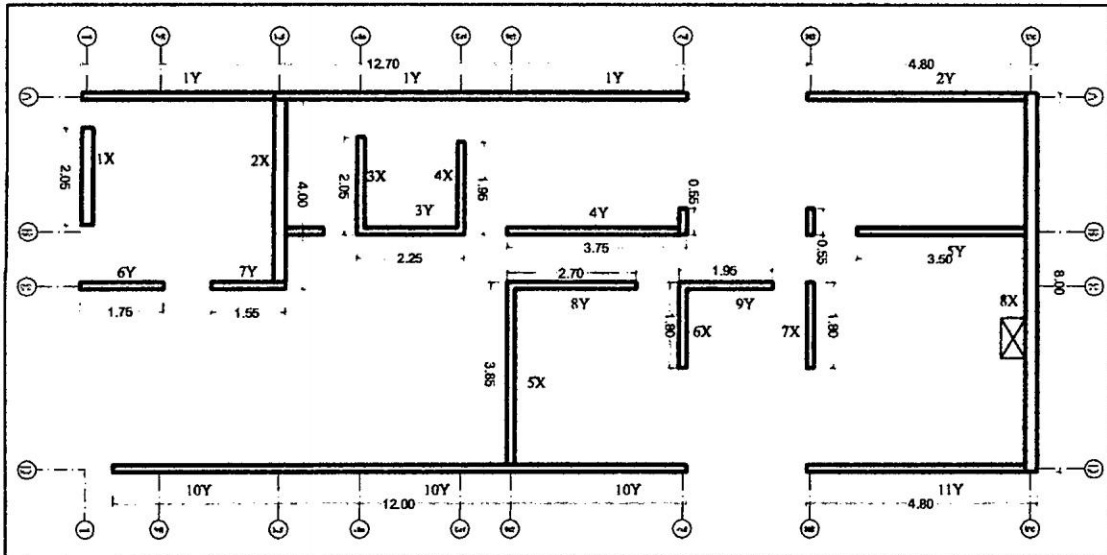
Estructuración Preliminar del Albañilería confinada.
